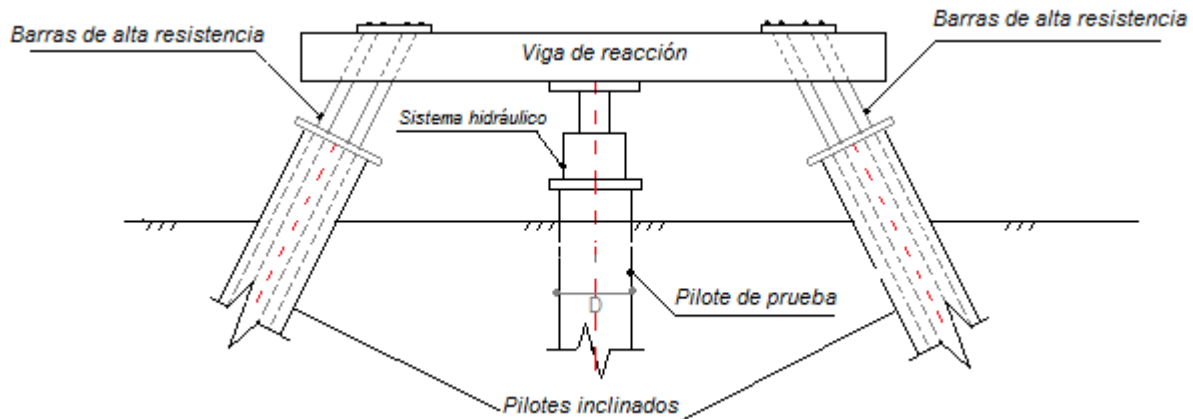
Pilotes inclinados, Manual de Diseño y Construcción de Pilas y Pilotes, Modificado de SMIG 1983.
